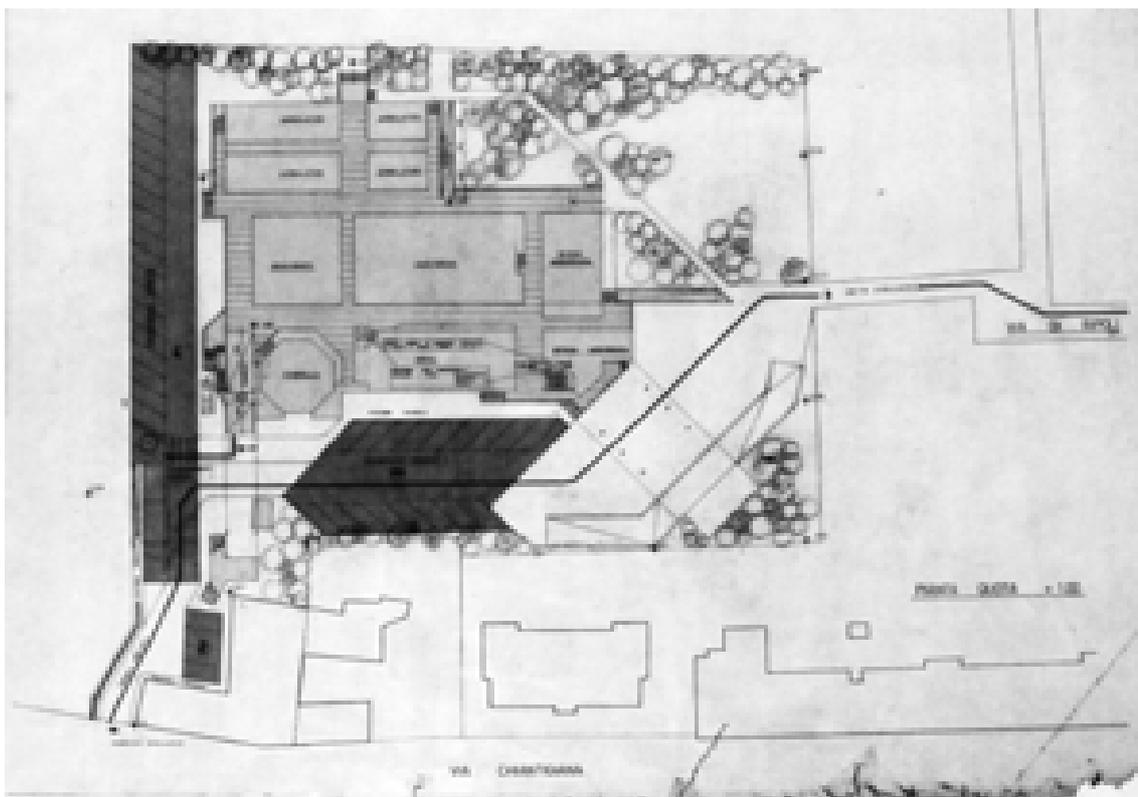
Planimetria con indicazione dell'uso dei vani – 02/08/1994 (AABS-64_379)
